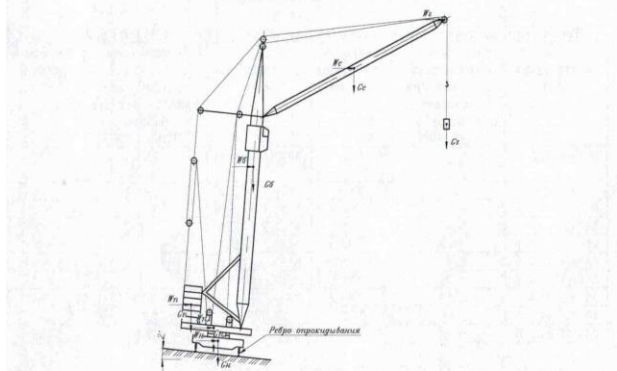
Расчетная схема грузовой устойчивости башенного крана
